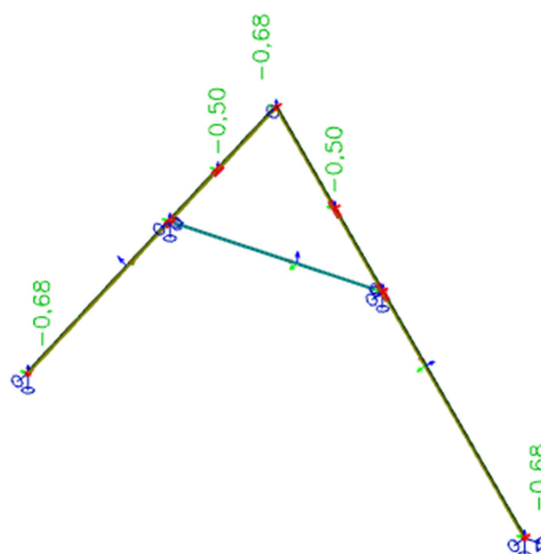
Konstrukce 3, Zatěžovací stav ZS4
